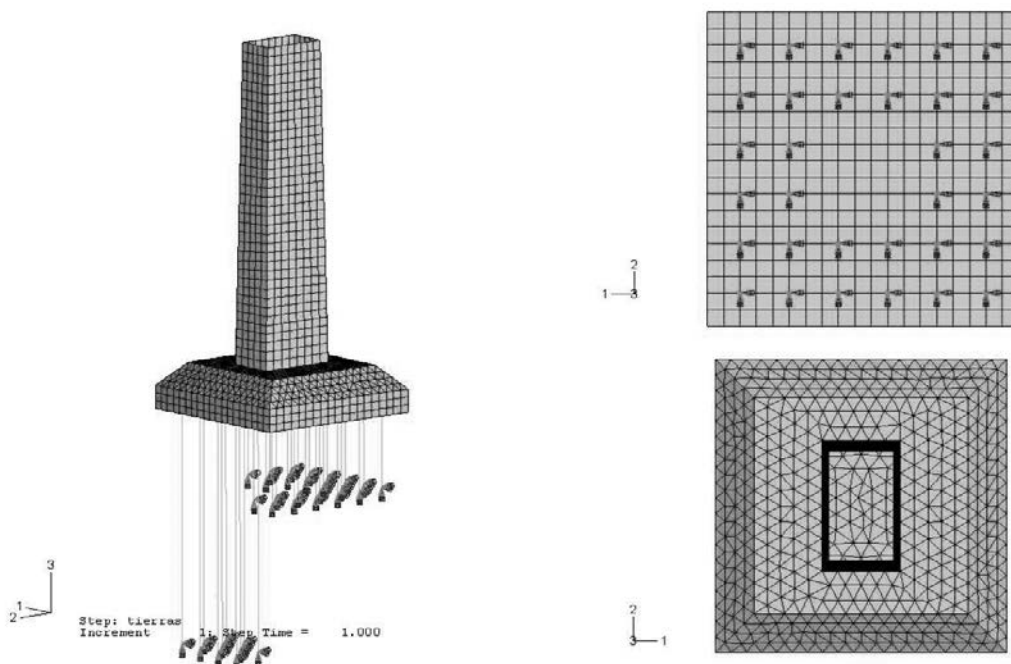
MEF para el cálculo de la cimentación de la pila 4.
